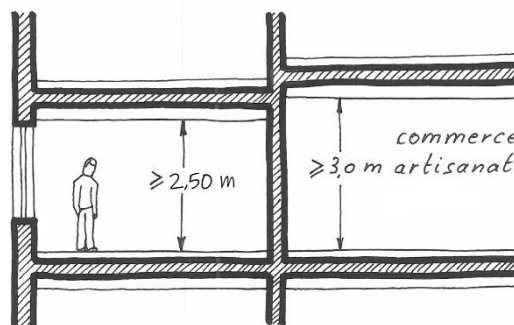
Hauteur minimale sous plafond pour les niveaux pleins
